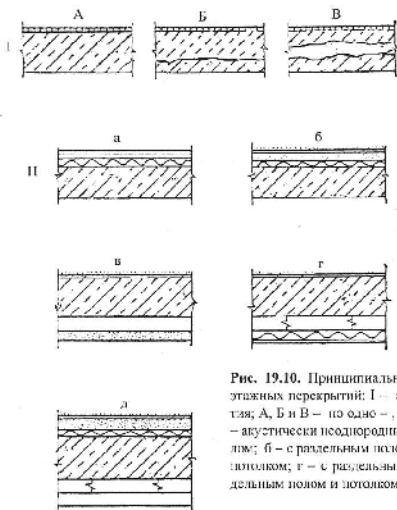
Принципиальные схемы звукоизоляции междуэтажных перекрытий: I — акустически однородные перекрытия; А, Б и В — по одно-, двух- и трехслойным панелям; II — акустически неоднородные перекрытия: а — со слесеным полом; б — с раздельным полом; в — с раздельным самонесущим потолком; г — с раздельным подвесным потолком; д — с раздельным полом и потолком
